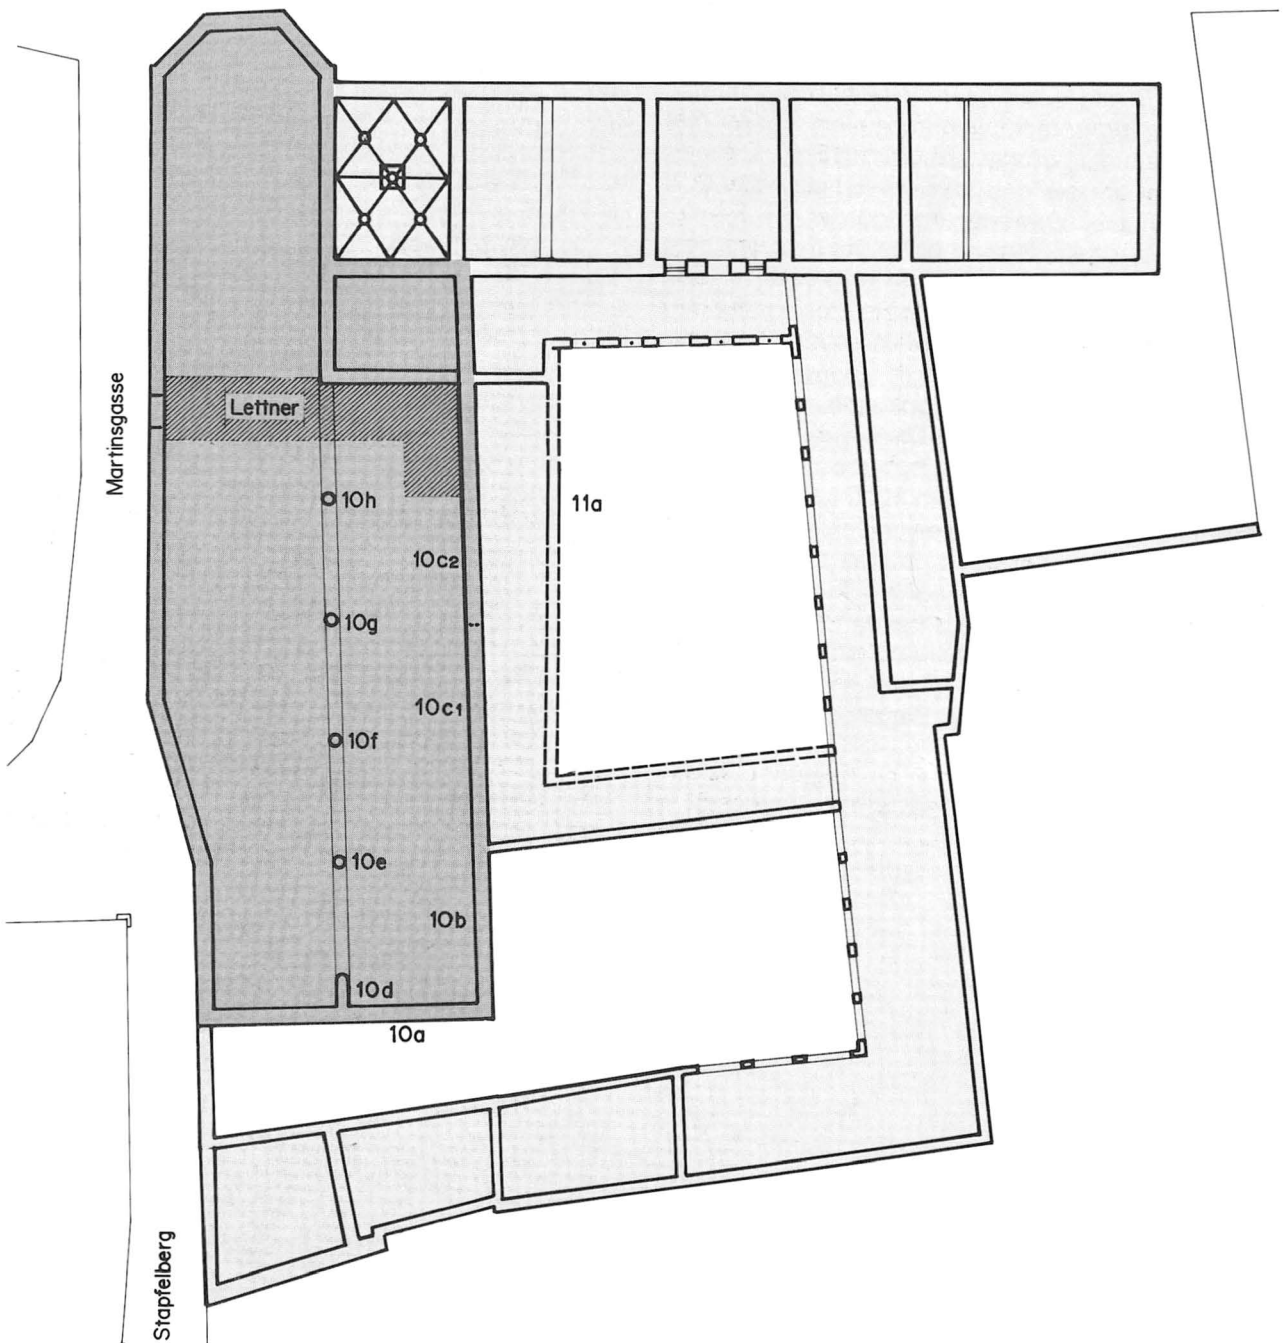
Grundriss des Klosters mit den Umgestaltungen von 1320 ff. (Kirche II, Sakristei) und späteren Umbauten (bis um 1500). Rekonstruktion. – Masstab 1:400.
